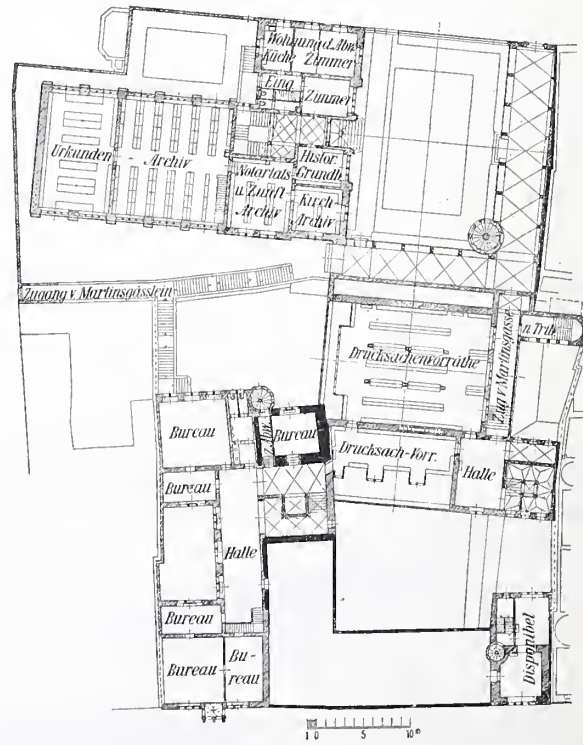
Grundriss vom III. Stock 1:800.
